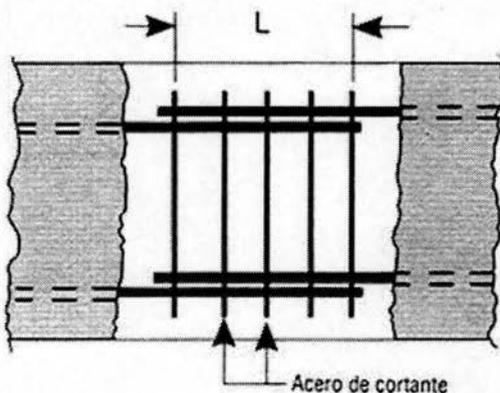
Refuerzos – Enmiendas para reconstruir la sección de acero de refuerzo, por traslape
